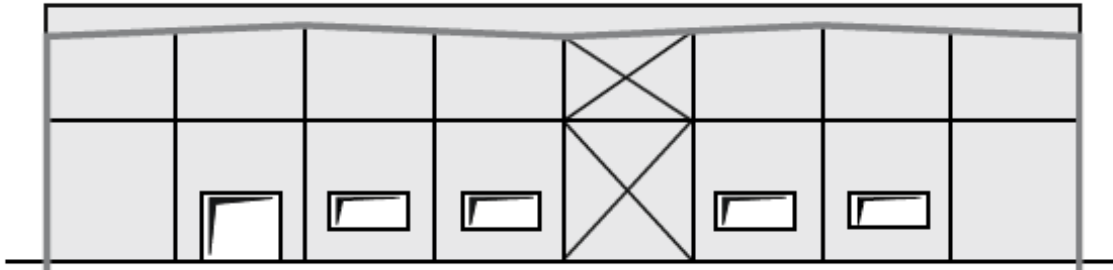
Élévation de la façade Nord (File 1) + ossature
